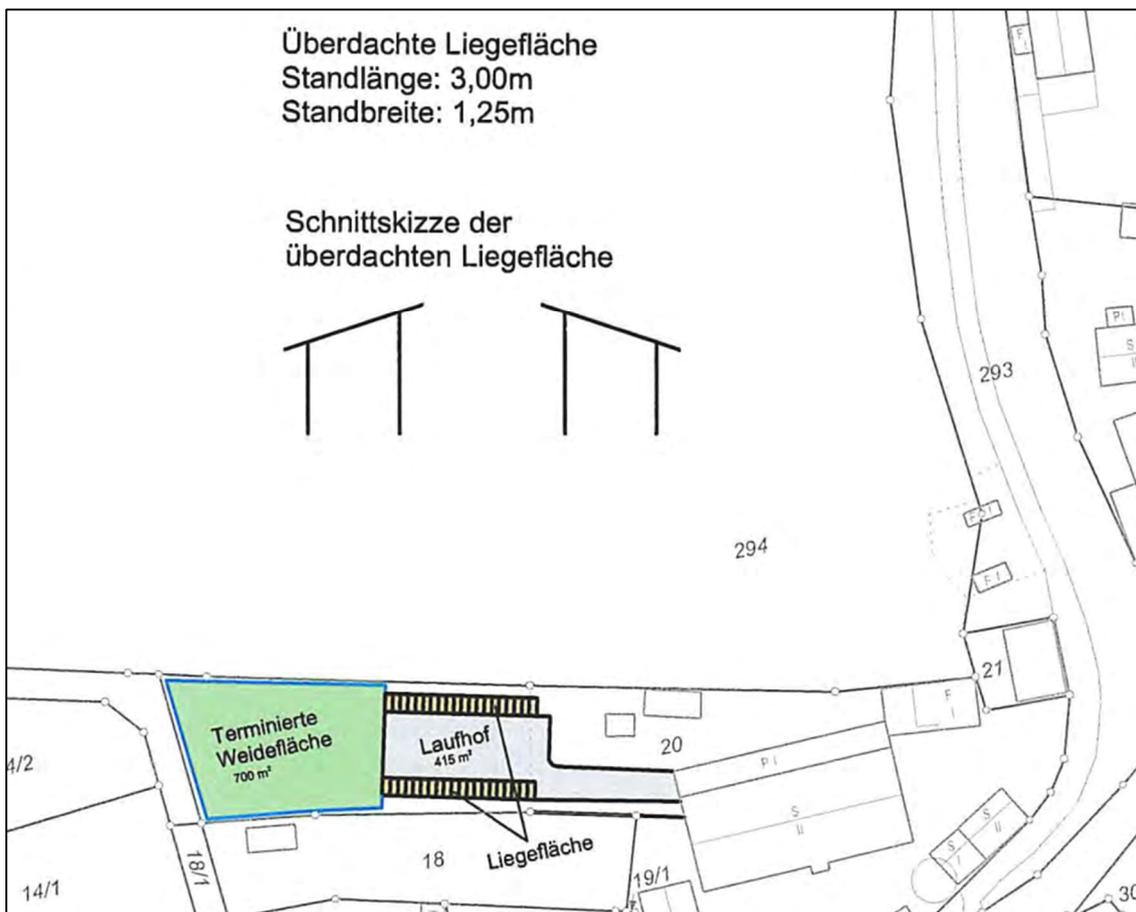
Planskizze zur Bauvoranfrage Laufhof Betrieb Meiler
